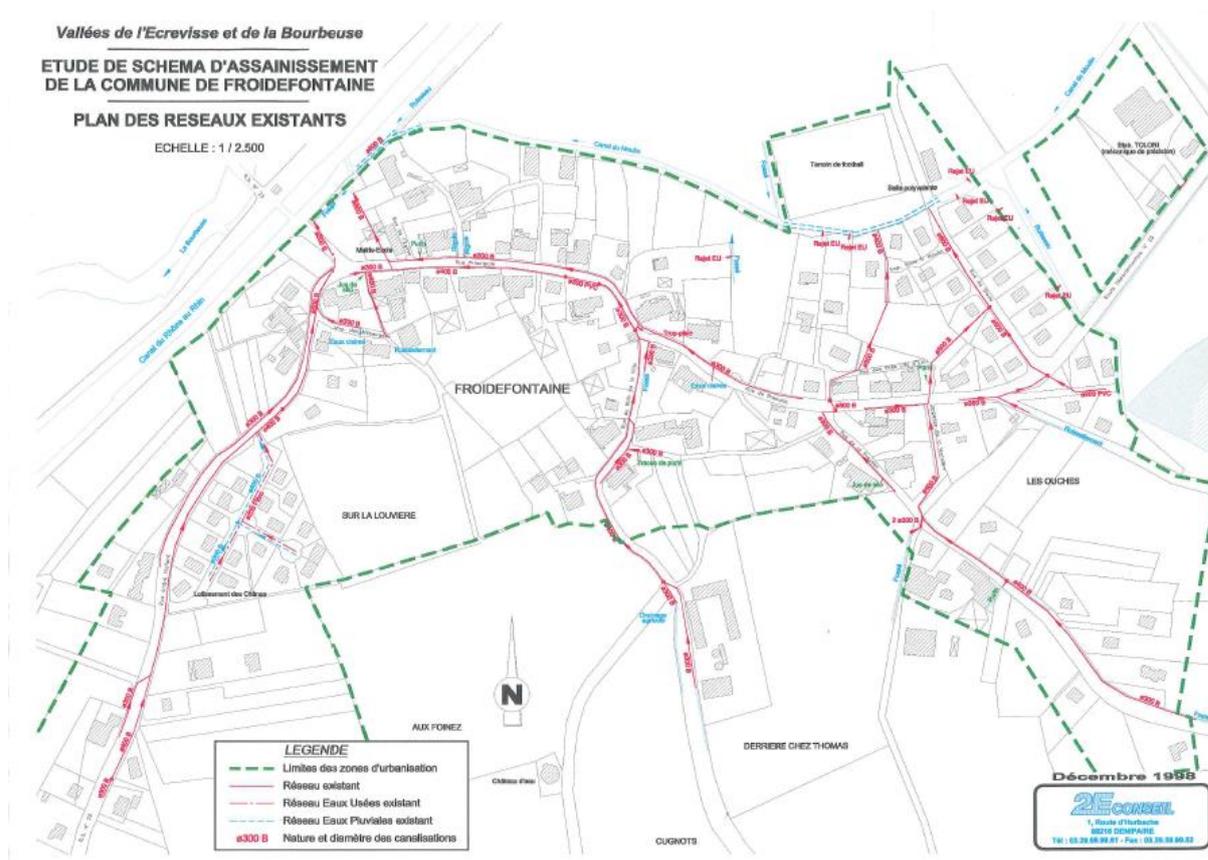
Plan des réseaux existants (source projet SDA 1999)
